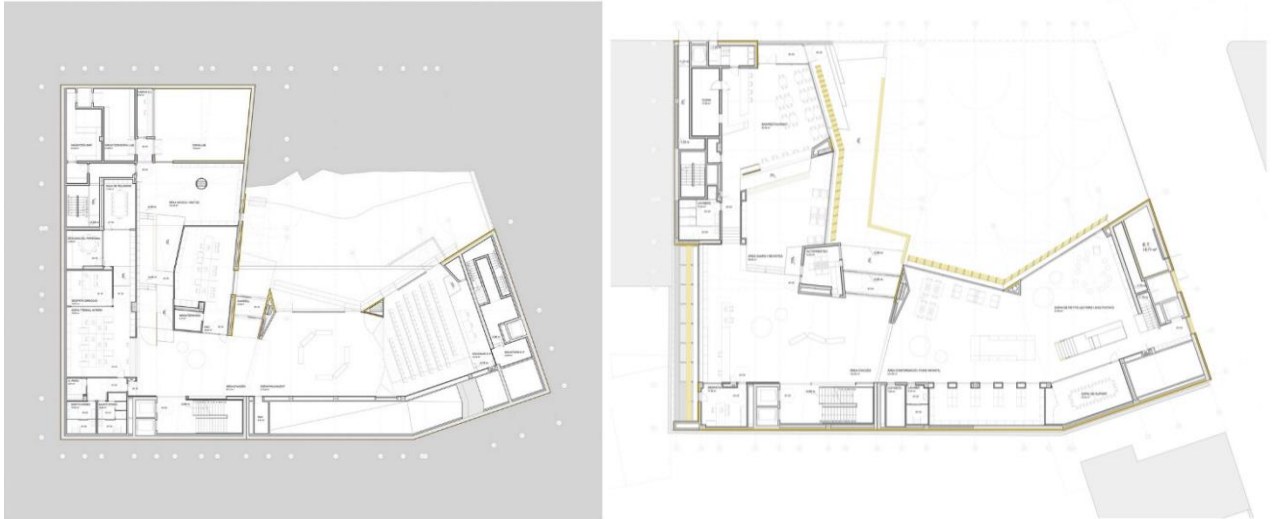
2.9. Бібліотека Піларіна Байєса – план 1-го і 2-го поверхів [14]
